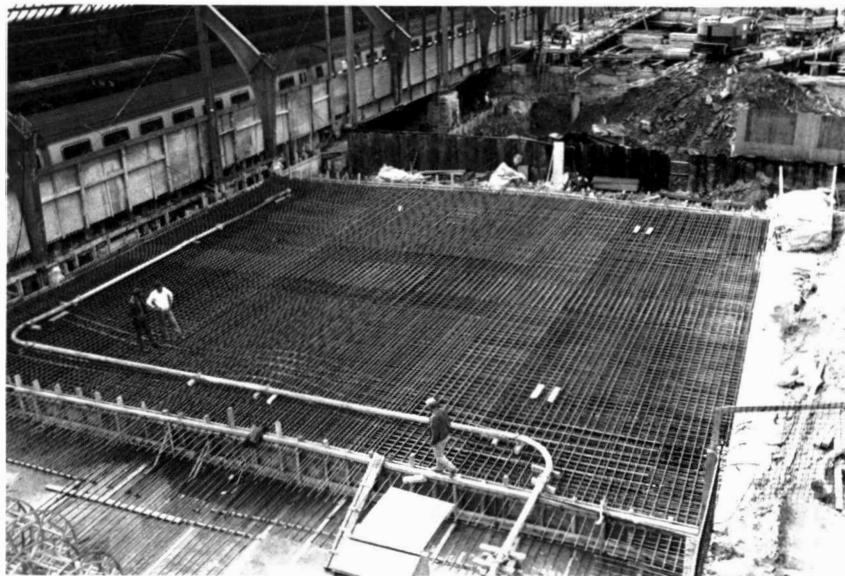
Obere Decke, Armierung – Dalle supérieure, armature – Upper floor slab, reinforcement
